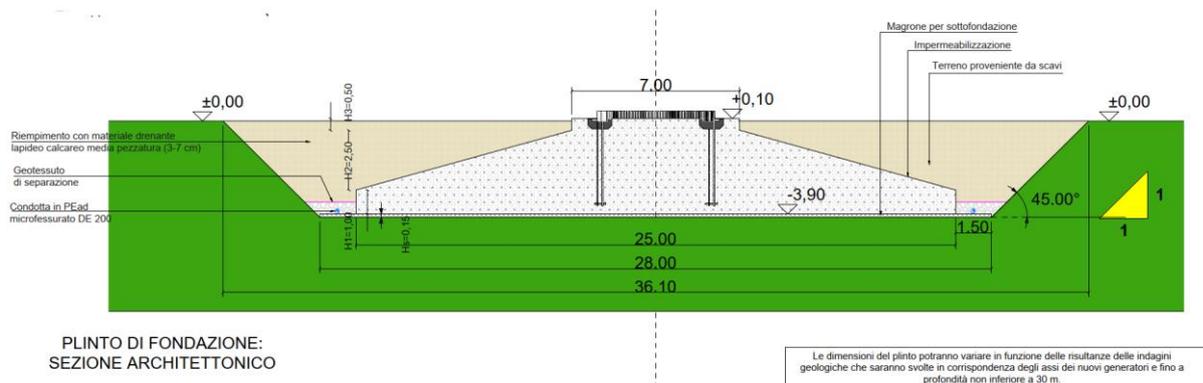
Stralcio Elaborato di Progetto “NIR.ELB05b” Schema Plinto Aerogeneratore - Sezione
